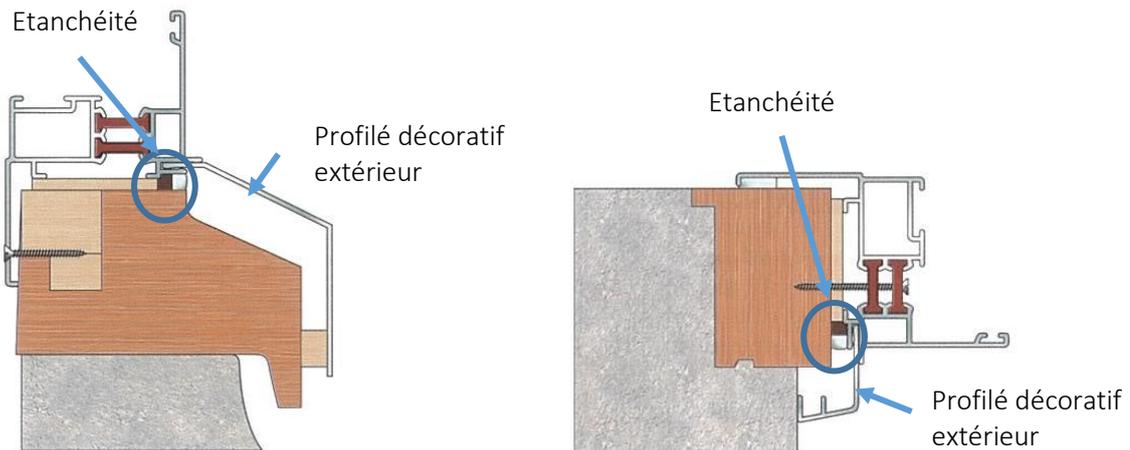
Etanchéité de la traverse basse (à gauche) et des autres montants (à droite)
